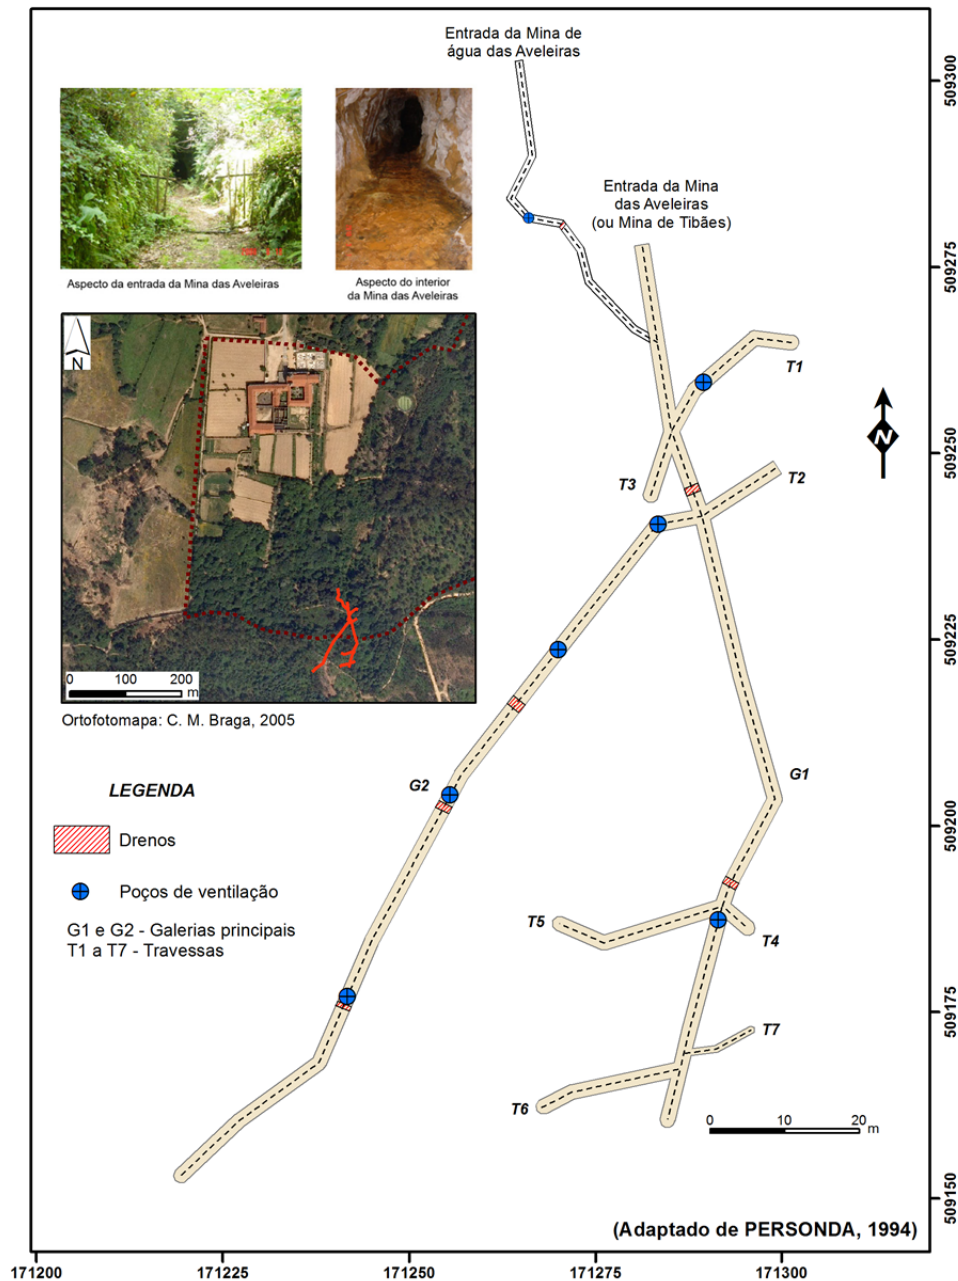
Planta do traçado subterrâneo da mina das Aveleiras, Tibães: galerias, travessas e poços de ventilação (adaptado e actualizado de Personda, 1994) – in: Lopes (2012).
